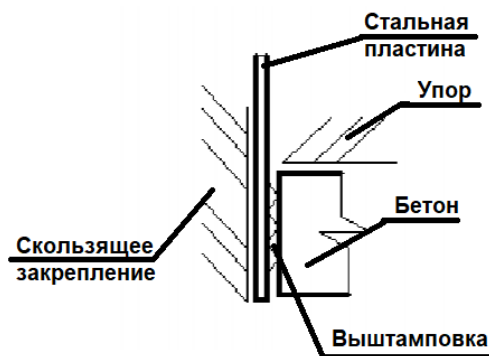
Расчетная схема испытания для выдергивания стального листа с использованием стальной обоймы
